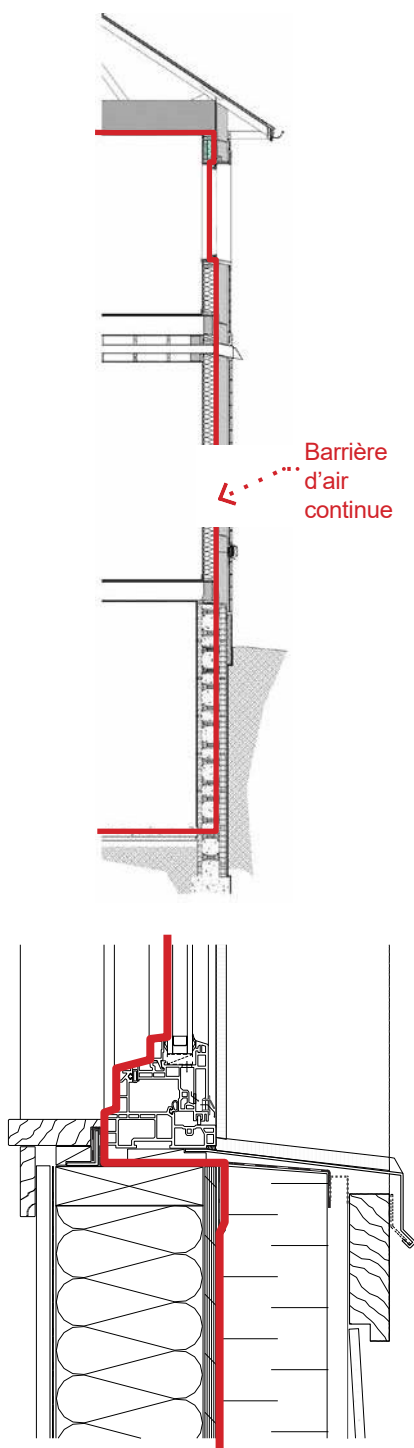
Exemple de lignes de continuité du pare-air dans toute l'enveloppe du bâtiment, y compris tous les détails de transition.
